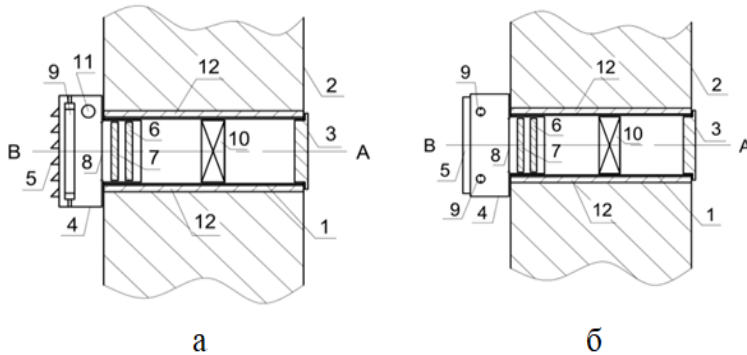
Клапан приточной принудительной вентиляции с очисткой воздуха: а – вертикальный разрез А-А; б – вид сверху; 1 – пластиковая труба; 2 – наружная стена; 3 – решетка с сеткой; 4 – пластиковый оголовок прямоугольной формы; 5 – щели; 6 – фильтр с сорбционной загрузкой шунгитом (фракции 1 мм); 7 – фильтр с сорбционной загрузкой цеолитом (фракции 1-3 мм); 8 – тонкая пористая пластина диоксида титана (TiO_2); 9 – две ультрафиолетовые лампы с длиной волны 365 нм (УФ-А диапазона), мощностью 6 Вт каждая; 10 – электровентилятор; 11 – регулятор оборотов с выключателем; 12 – фольгированный изолон
